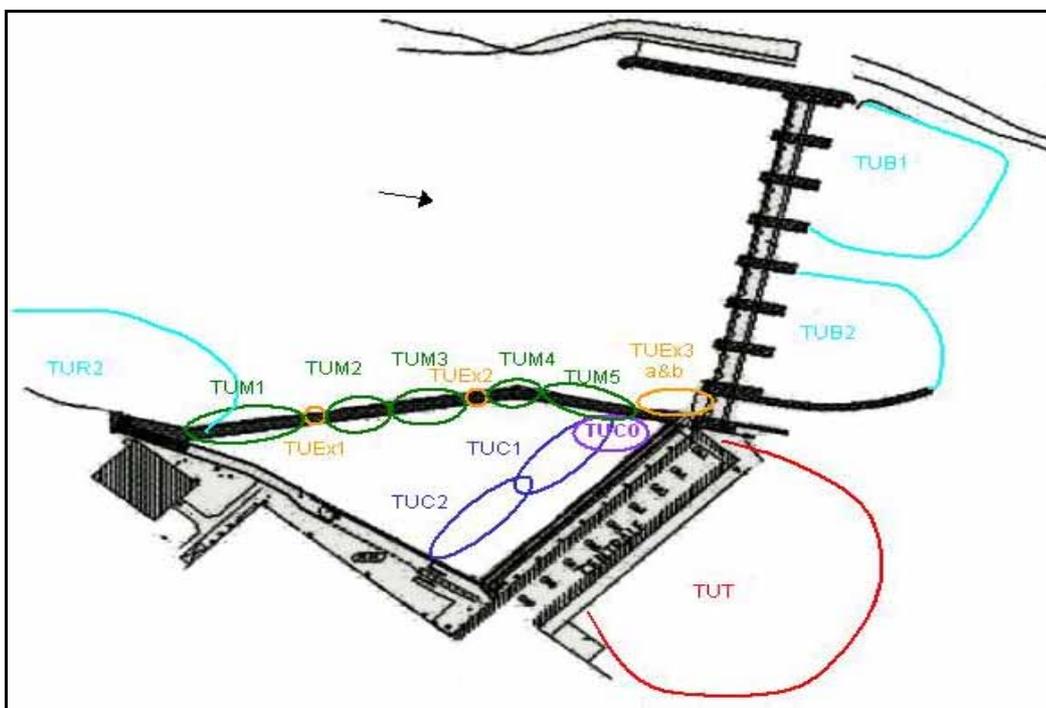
plan des différentes zones d'enregistrement sur le site de Tuilières
